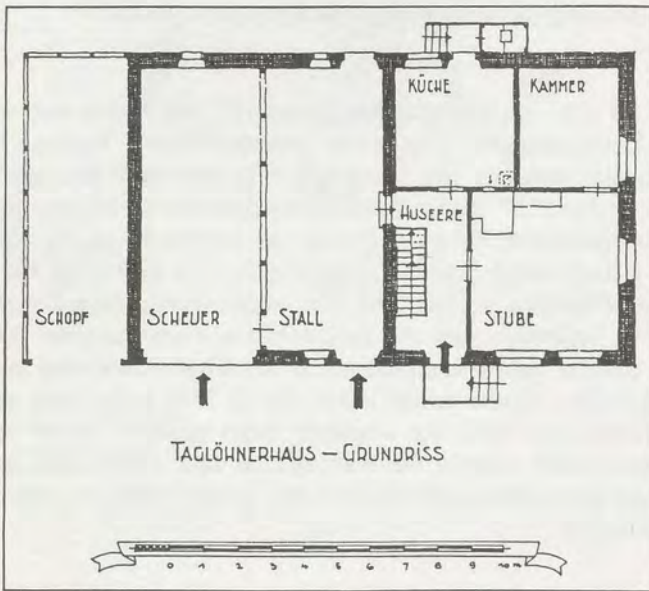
Grundriss eines Taglöhnerhauses dieses Typs
